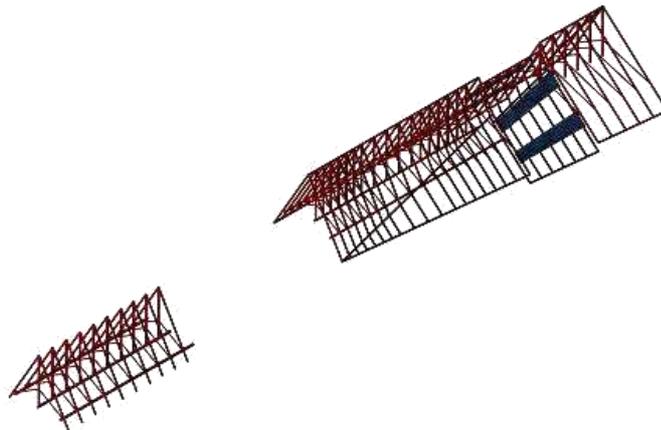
Aksometri Sambungan Kayu dengan Beton
